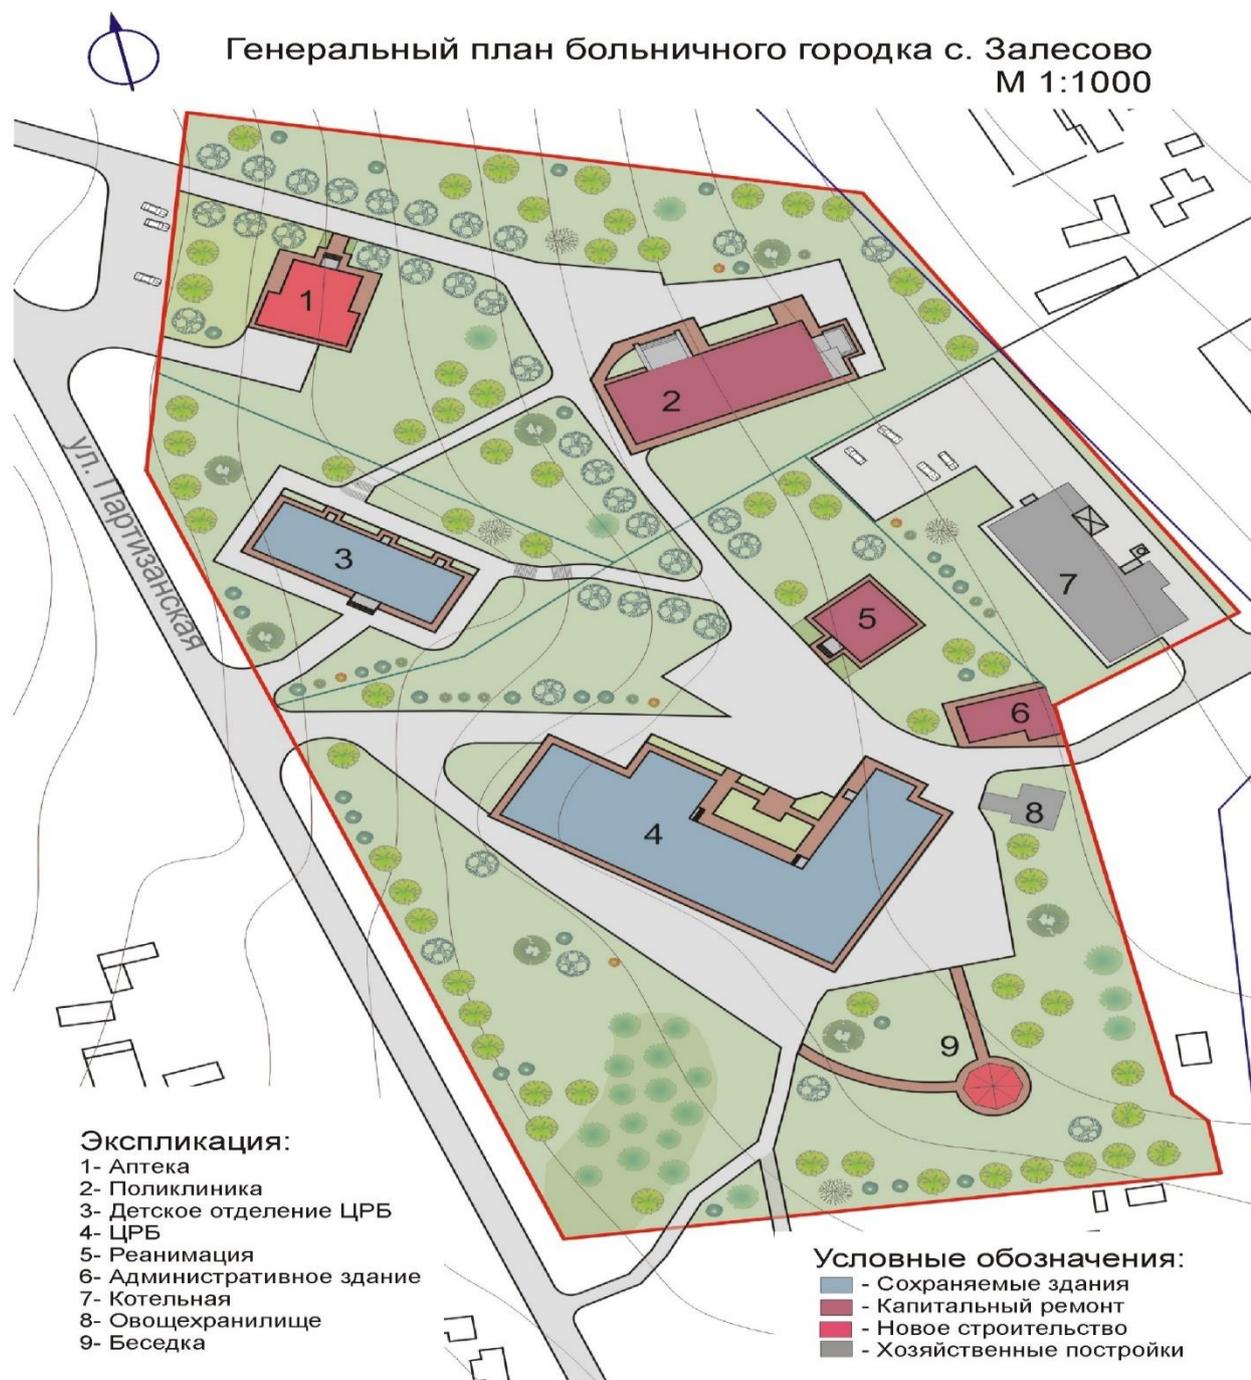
Генеральный план многопрофильной больницы на 300 коек
